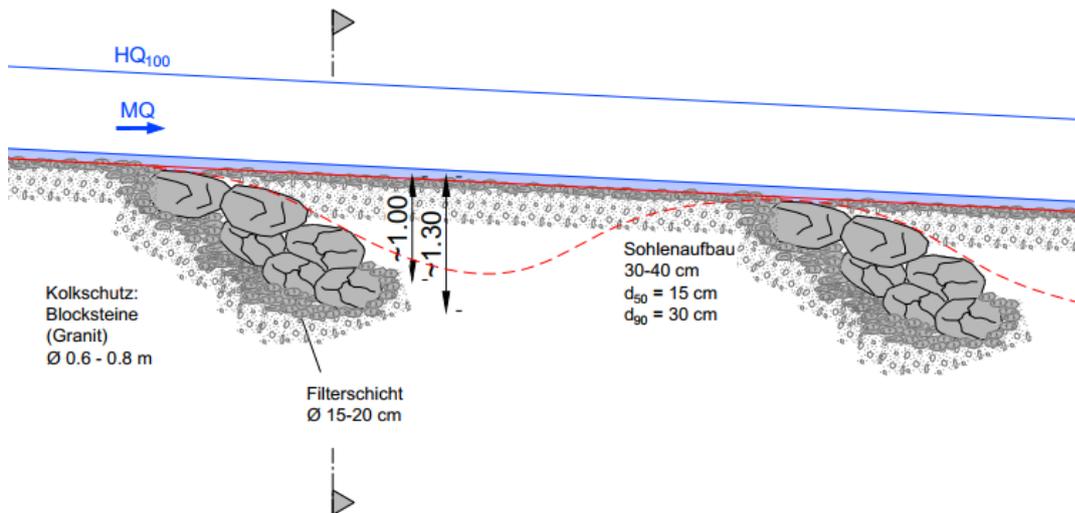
Normalprofil Blockrampe (Längsschnitt)
